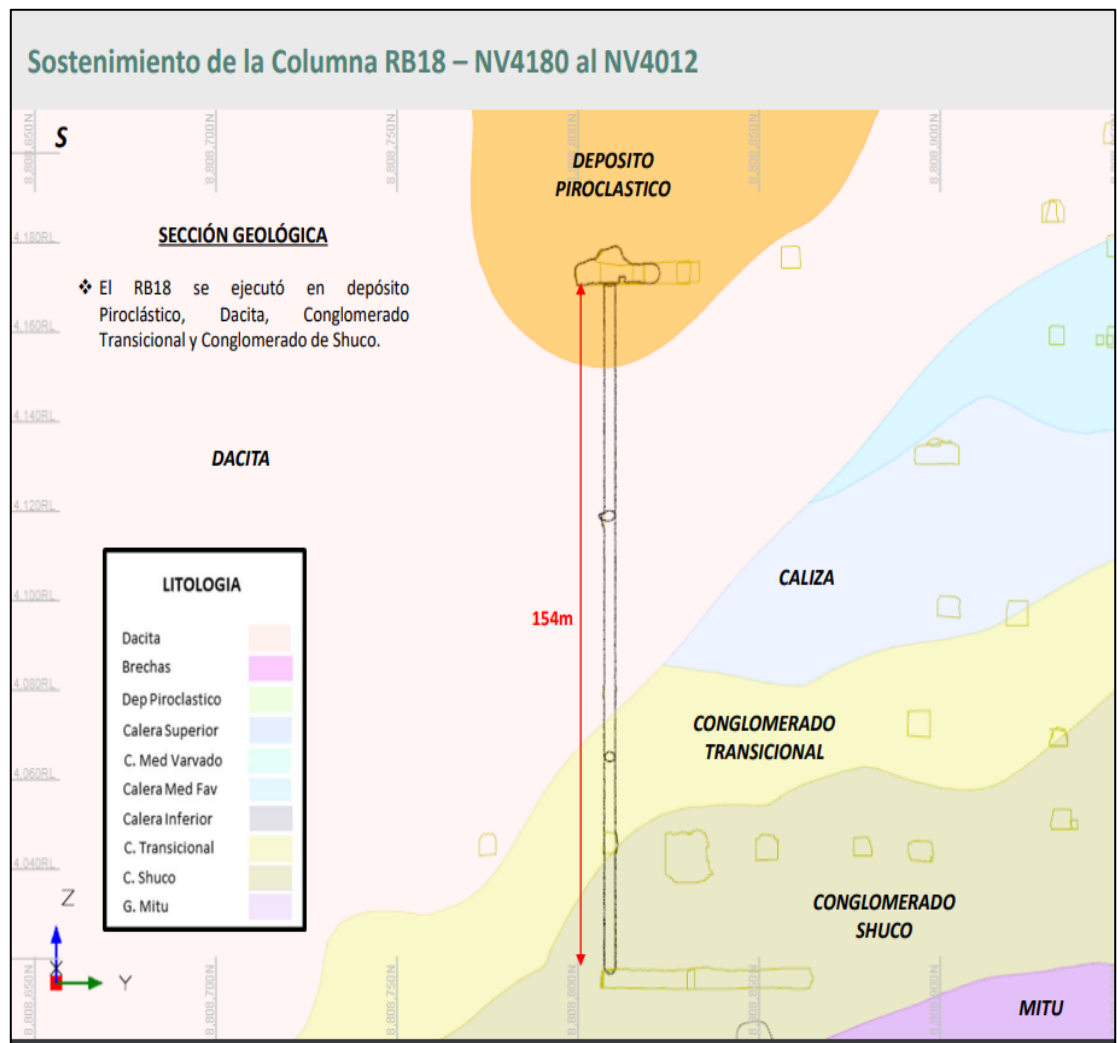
Plano Geomecánico Longitudinal de la Chimenea
